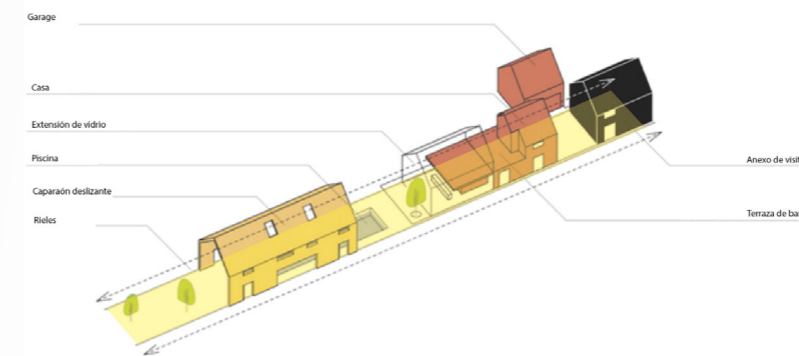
, esquema casa deslizante, dRMM architects, Inglaterra, 2009
